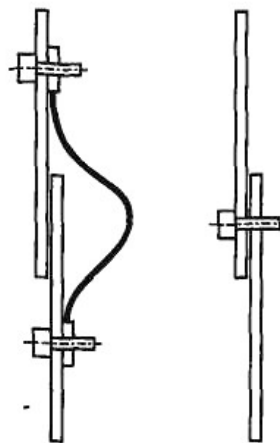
Соединение металлических частей фасада здания гибким проводом (а) или болтом (б)
